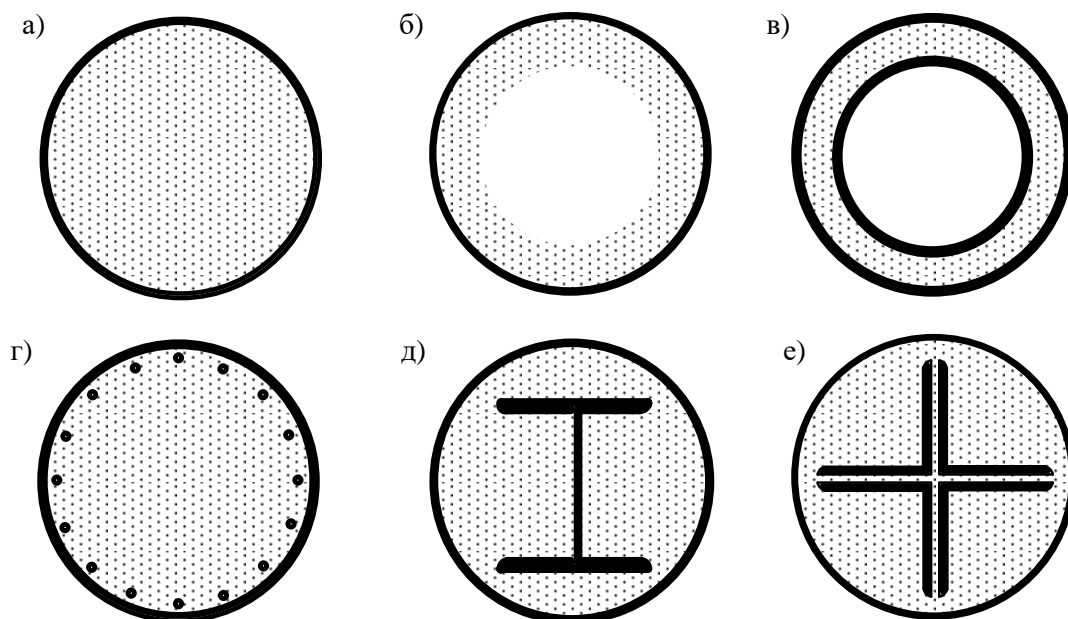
Перерізи круглих трубобетонних елементів: а - бетонне ядро суцільного перетину; б - елемент з ядром з центрифугірованного бетону; в - елемент «труба в трубі»; г - елемент з ядром, армованим стрижневий поздовжньою арматурою; д, е - елемент з ядром, армованим прокатними профілями.
